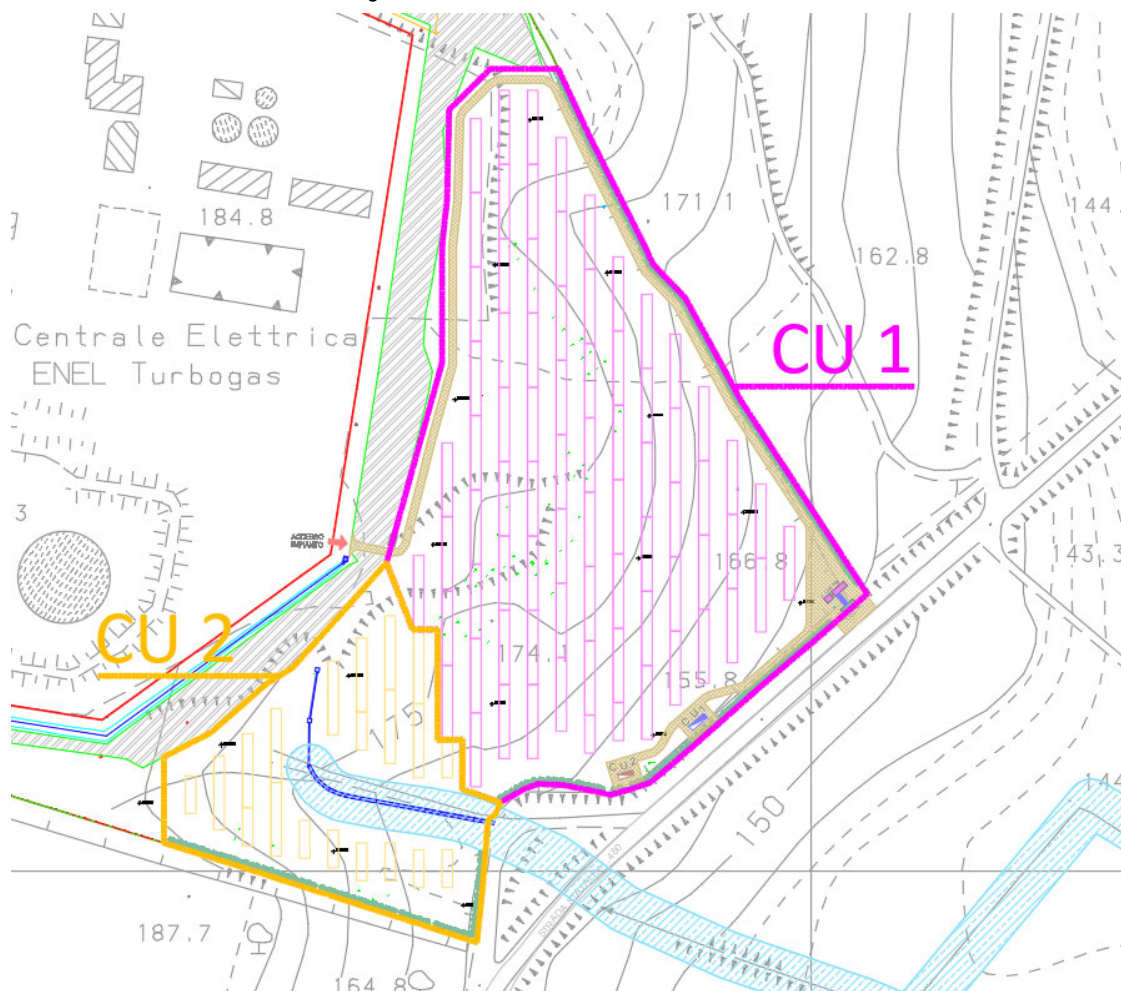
Individuazione delle strutture tracker collegate ai vari Cabinati di conversione
